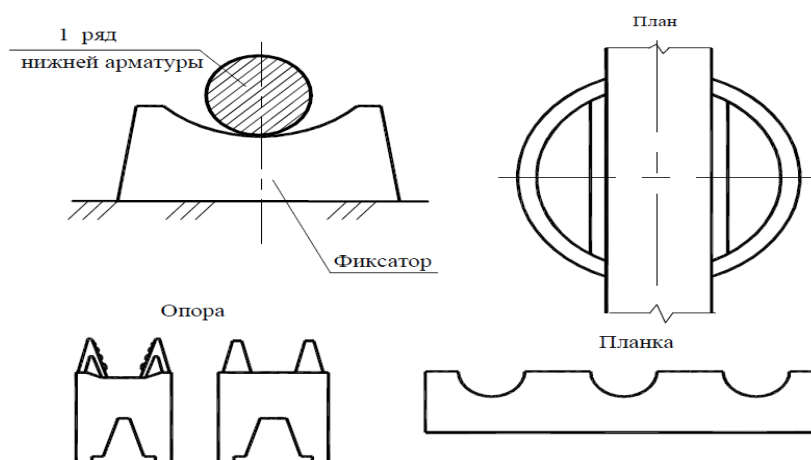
Фиксатор защитного слоя бетона для горизонтальной арматуры
